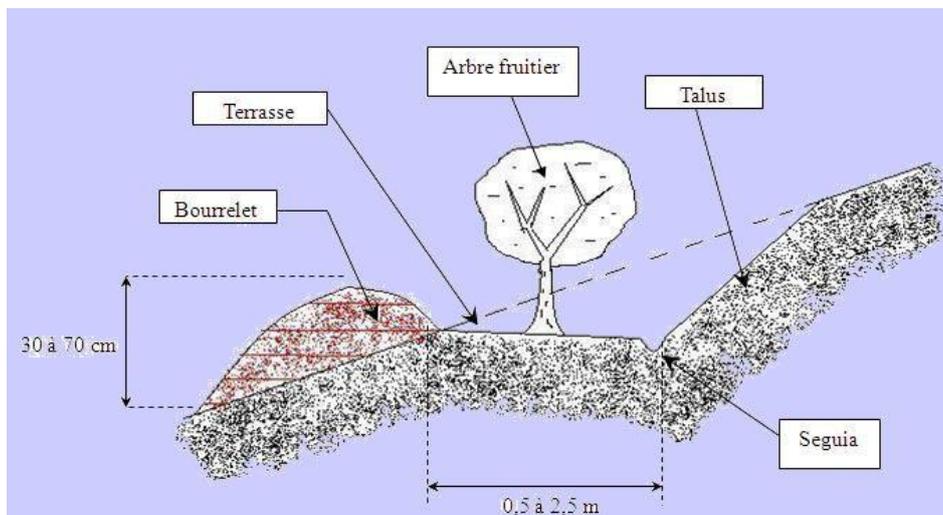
Coupe transversale d'une banquette associée à un fruitier.
